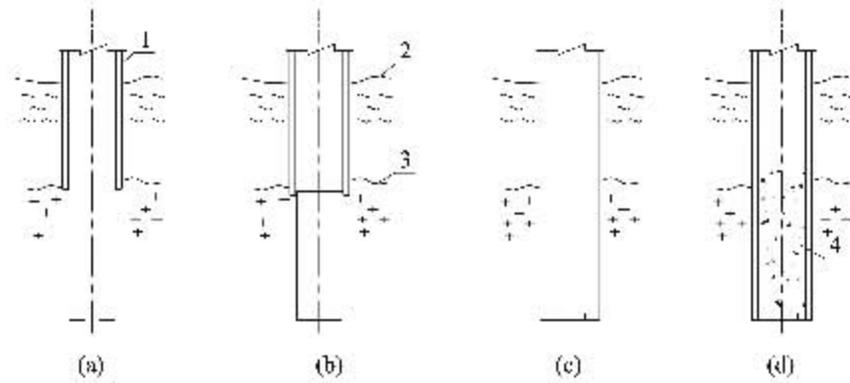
预制型植人嵌岩桩钻岩复打桩锚固法施工示意图
